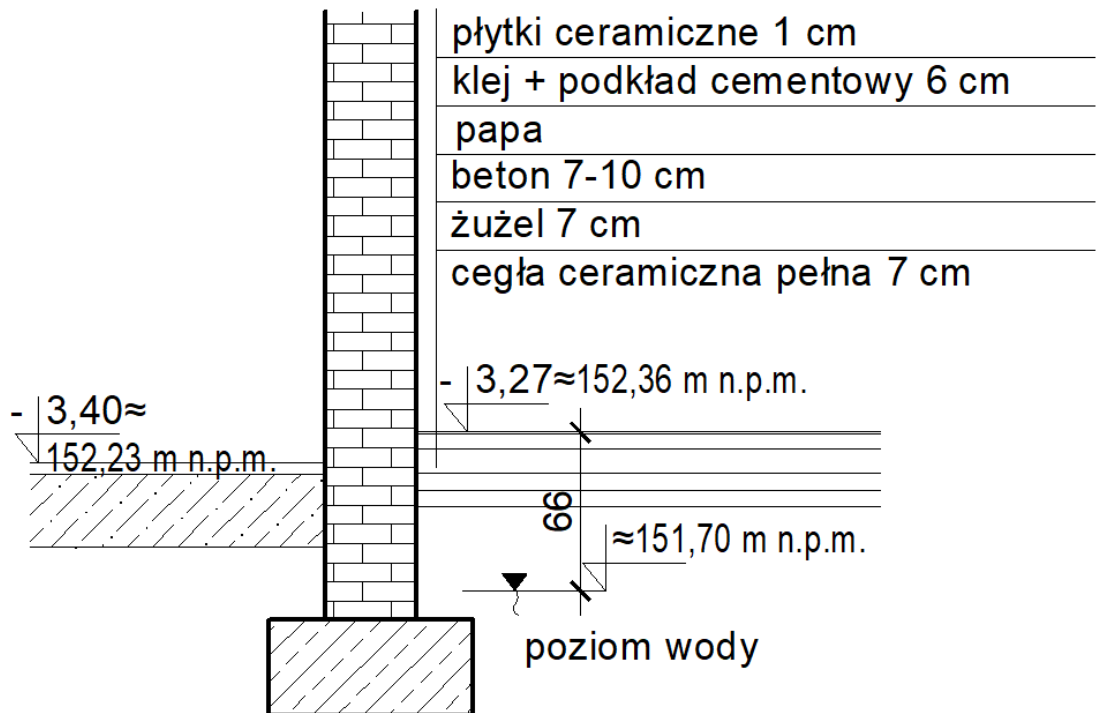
Wynik odkrywki nr 1 muru fundamentowego zewnętrznego
